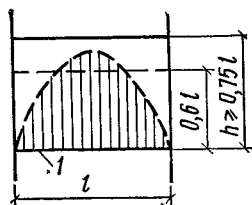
Расчетная схема ригеля глухого участка стены
